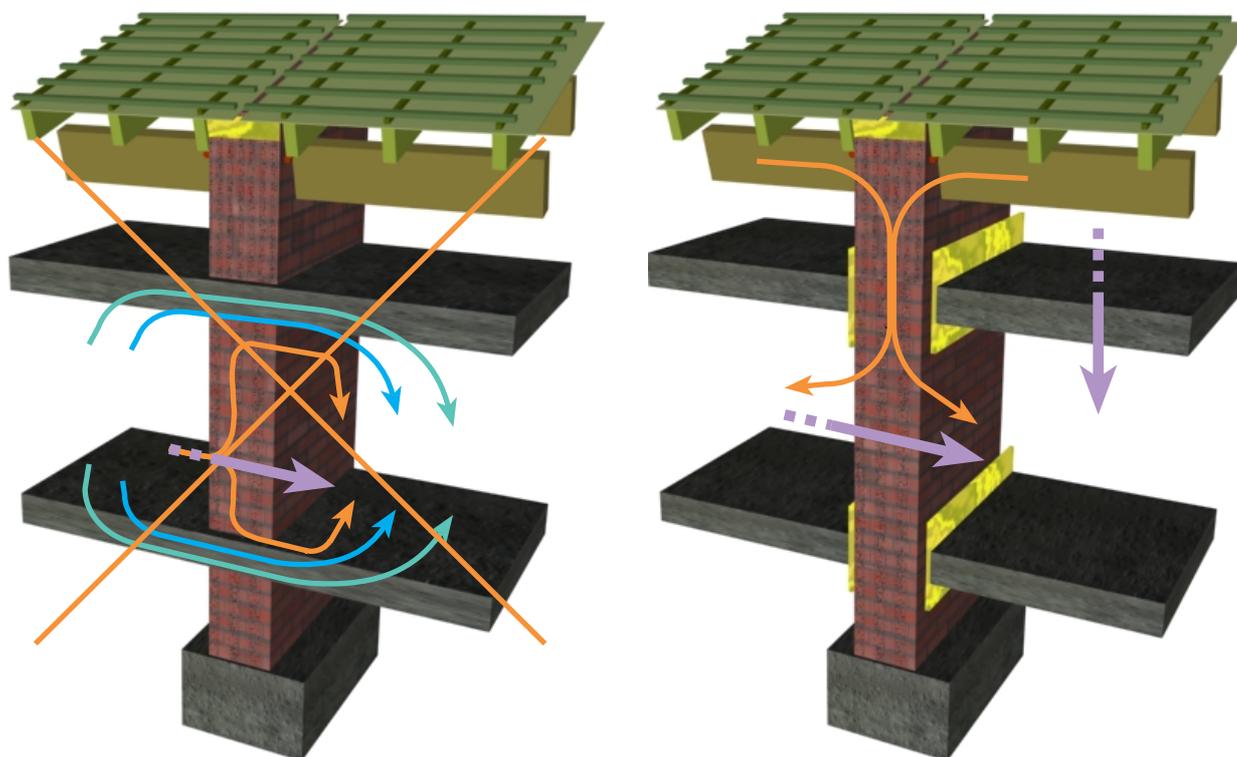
Le non-encastrement des planchers dans le mur mitoyen massif empêche la transmission latérale du bruit par le biais des planchers (figure de droite). Seul le transfert latéral subsiste.
